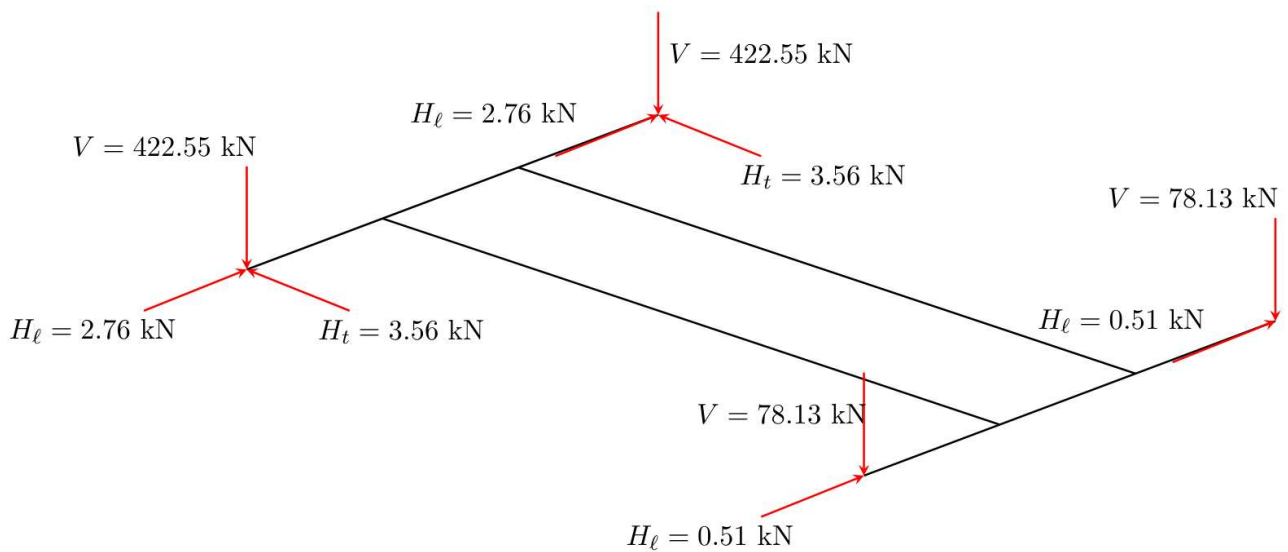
Distribución de cargas del puente grúa sobre la estructura de la nave (por rueda).
